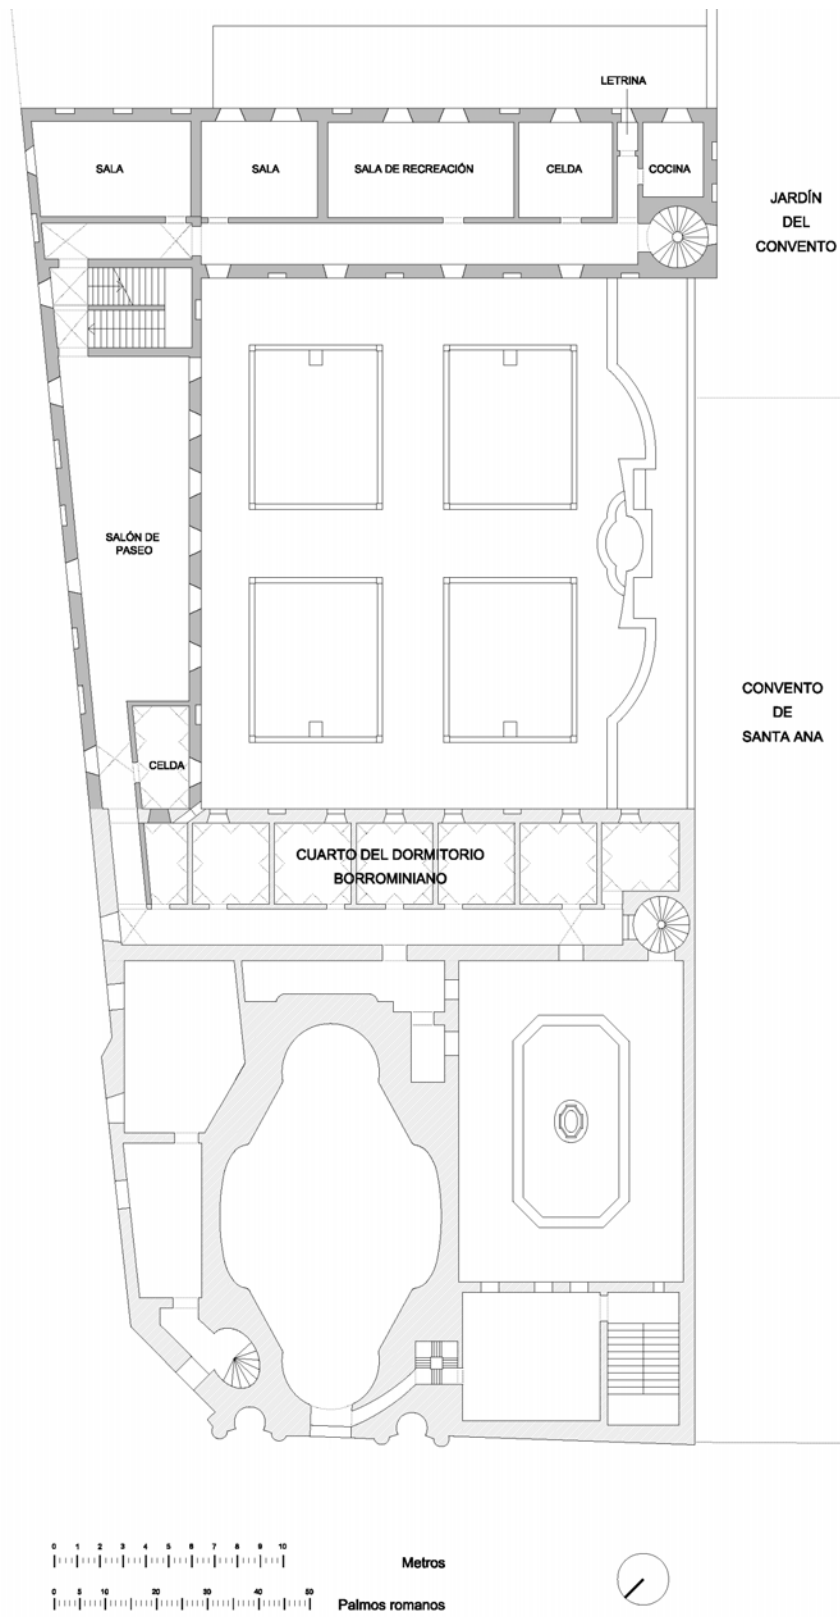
Disegno dell'autrice. Pianta secondo piano.
